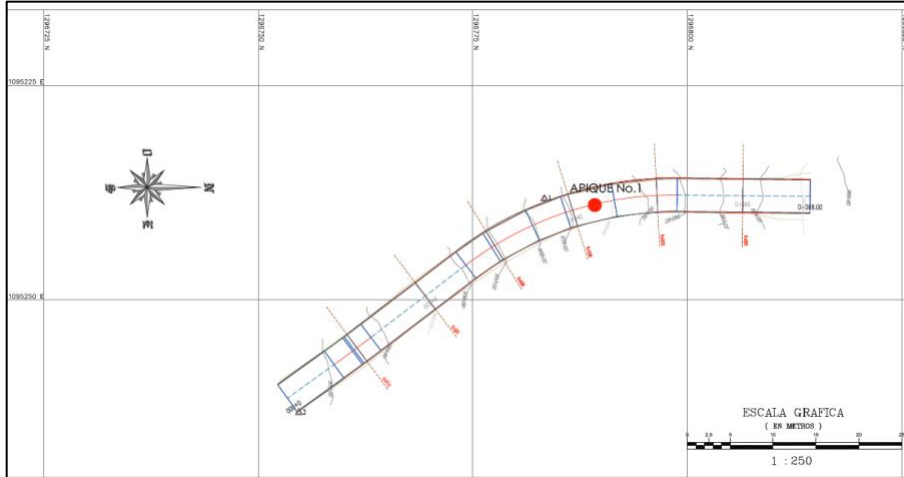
Imagen de planta del tramo 3 del proyecto de Rionegro-Santander
